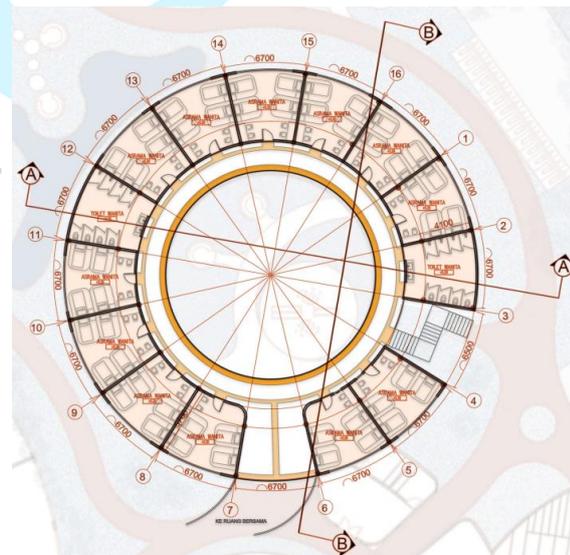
7 Denah Lt. 2 SDLB
